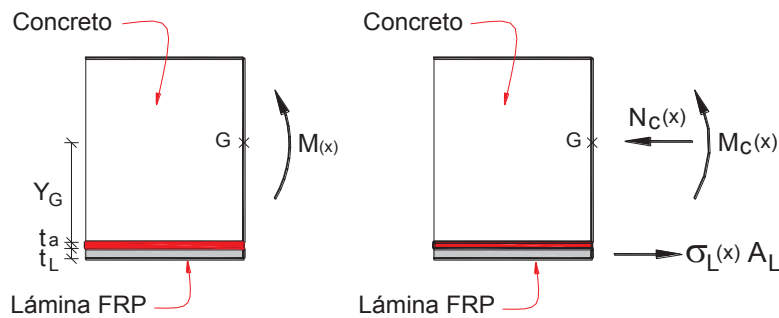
Fuerzas actuando en una sección diferencial de un elemento entre dos grietas existentes.
